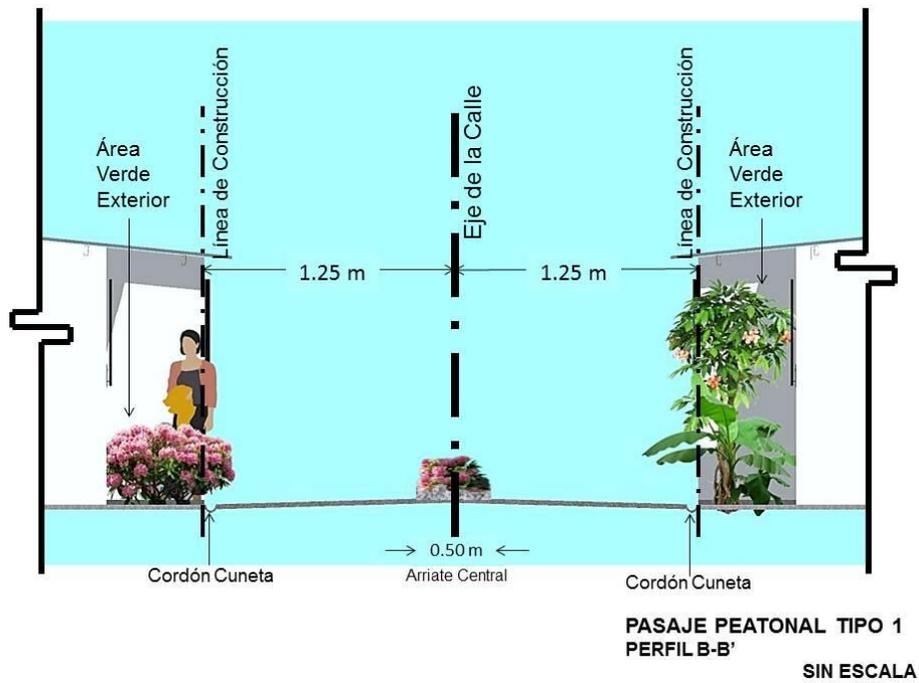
Perfil B-B' Pasaje Peatonal Tipo 1
